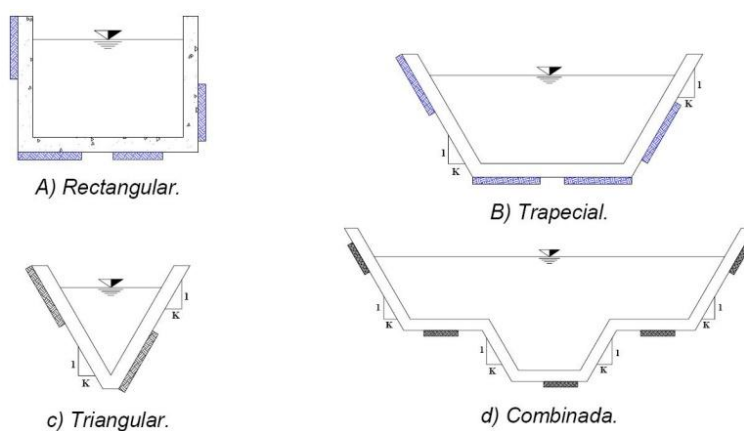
Secciones transversales de conductos a cielo abierto.
